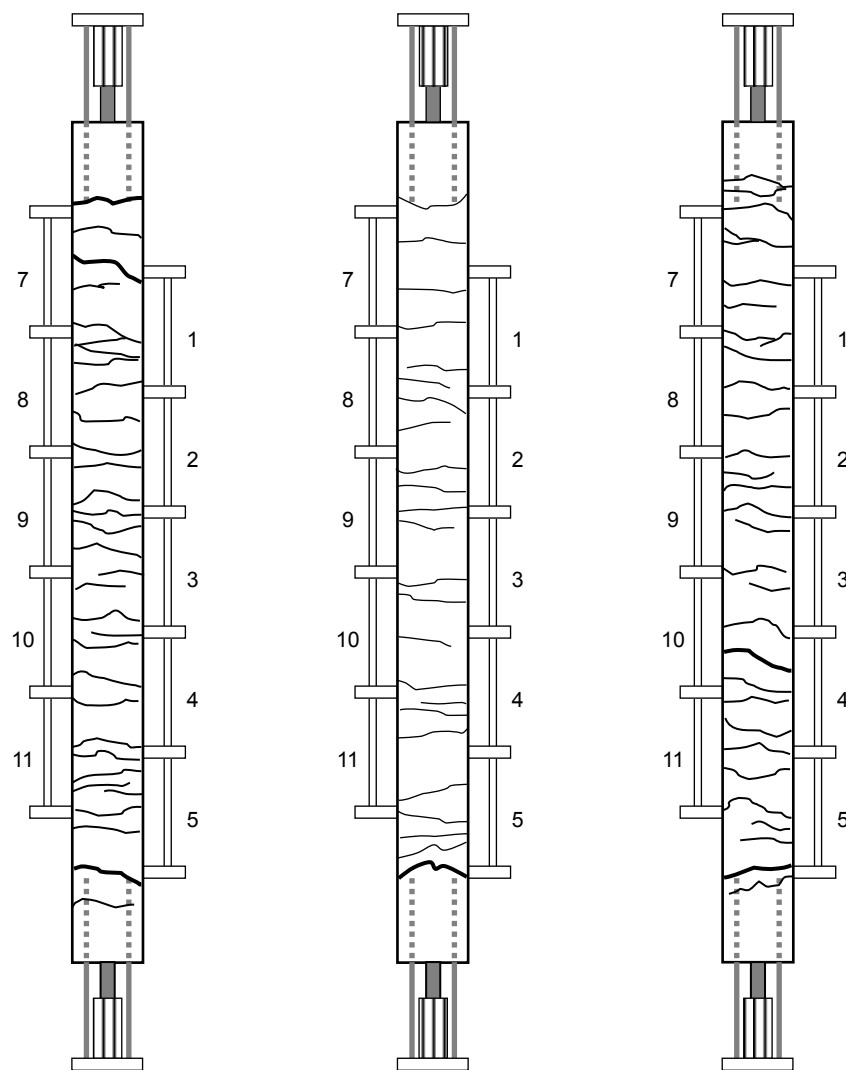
両引き試験体のひび割れ図(TS08-y)
